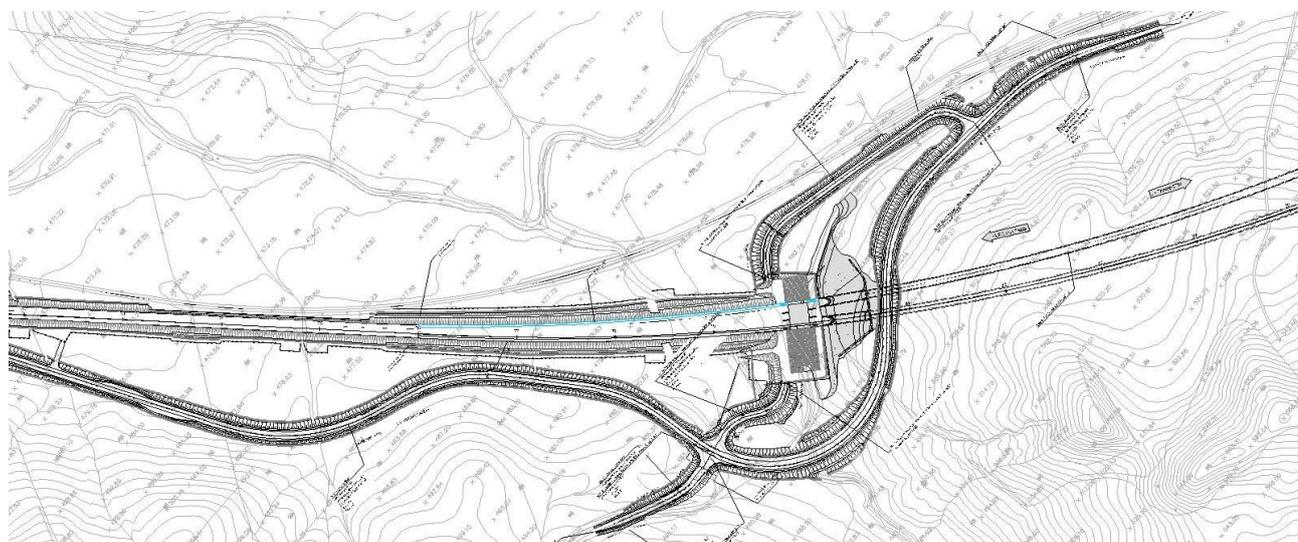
NV01 stralcio planimetrico da km 4+700 a fine intervento
